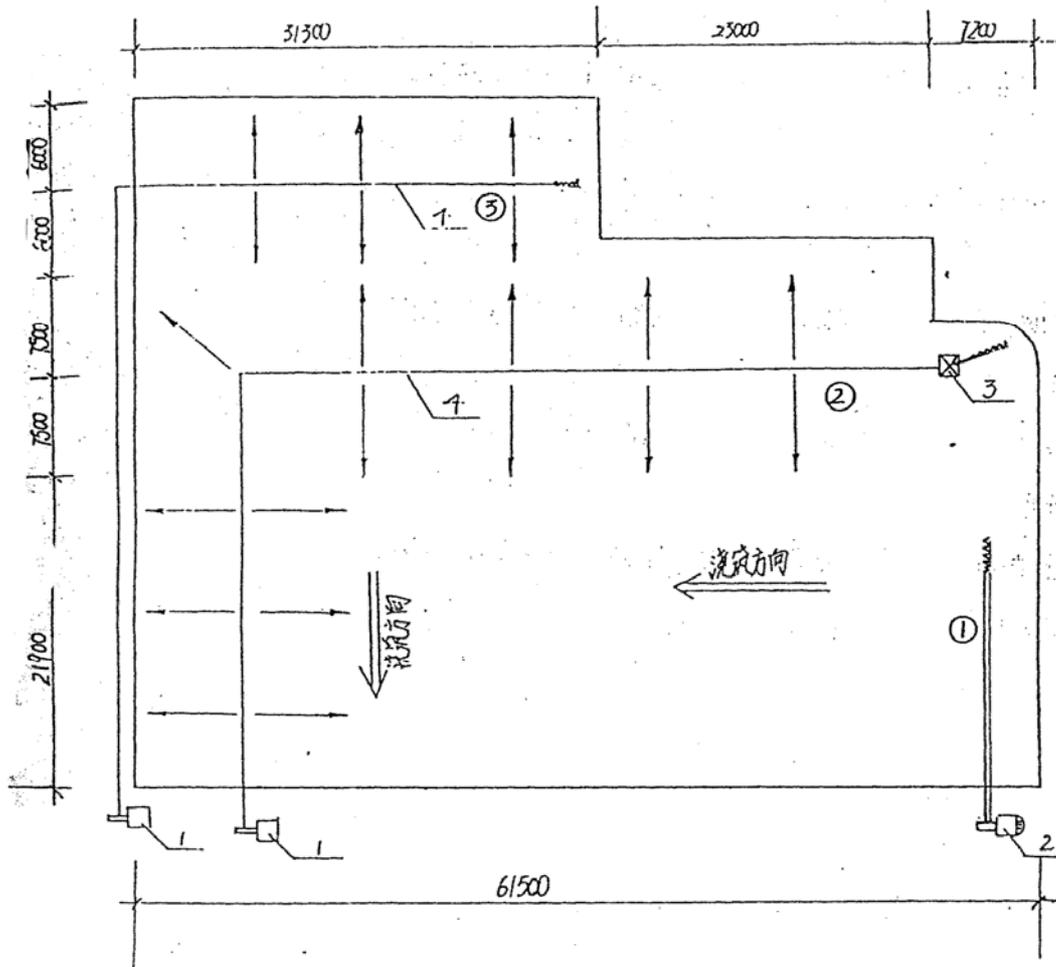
地下室底板混凝土浇灌顺序及泵车布置方案图
